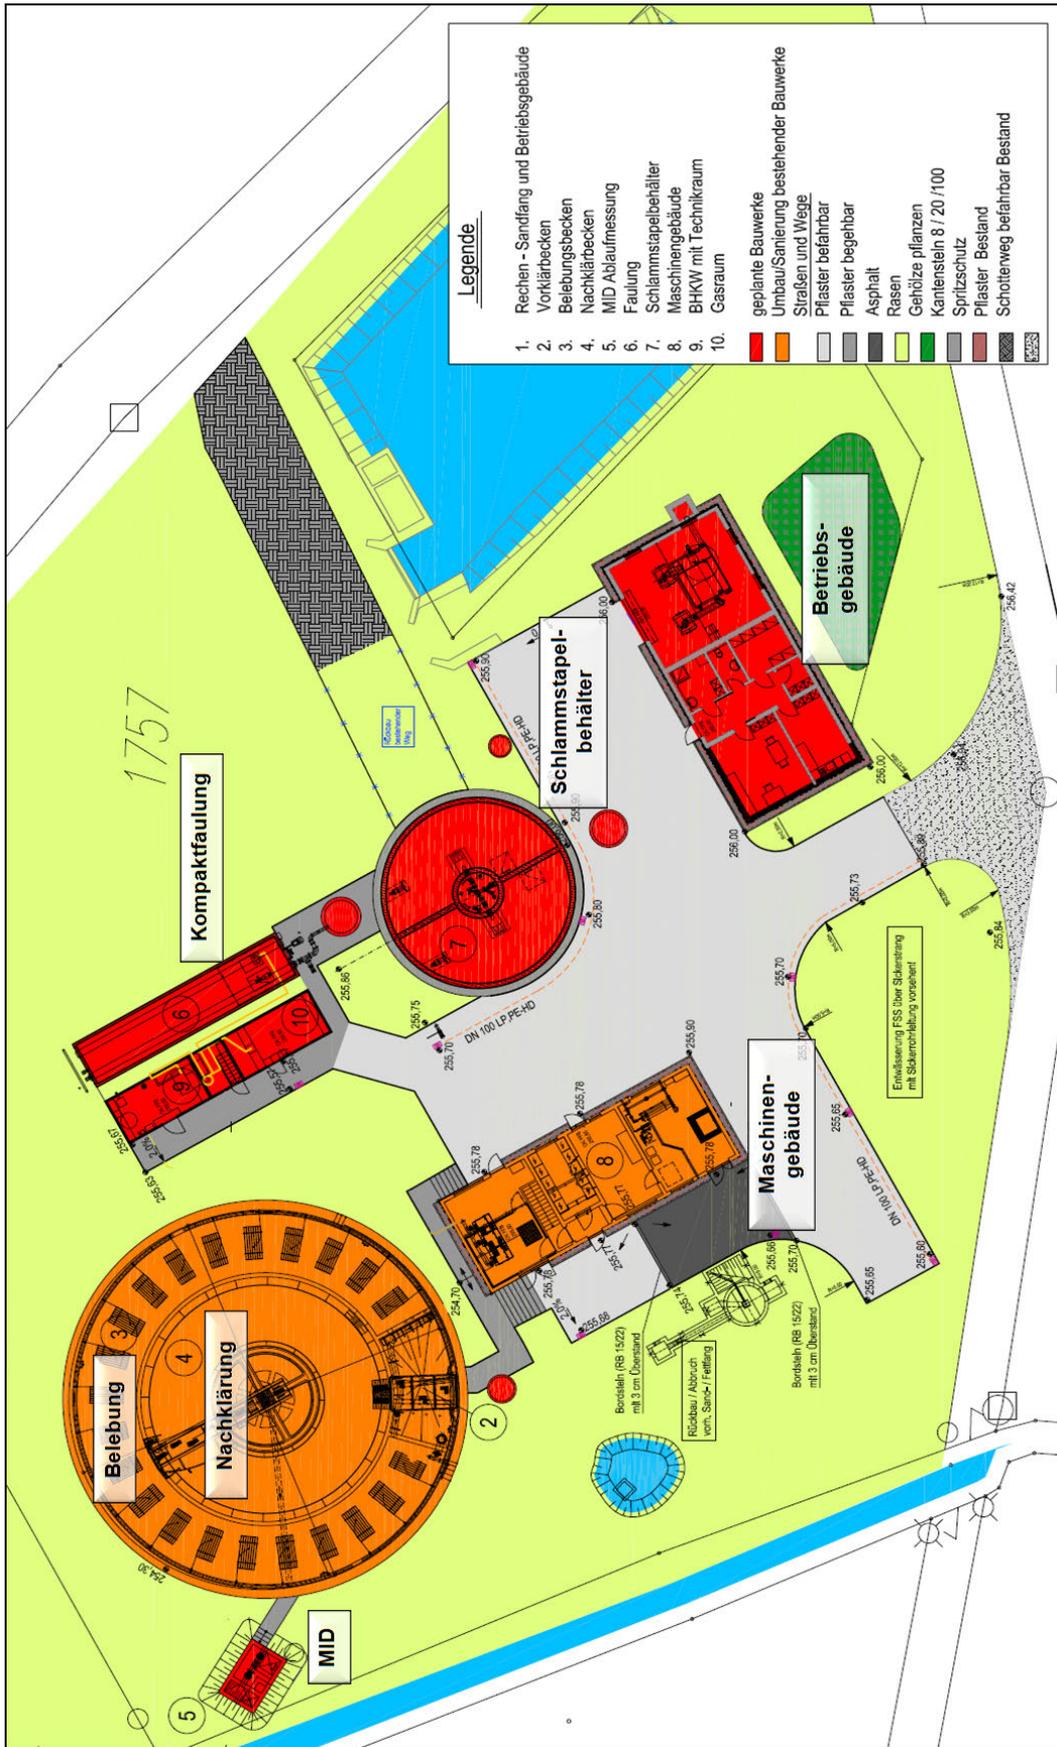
Lageplan der KA Steinfeld-Hausen nach dem Umbau
